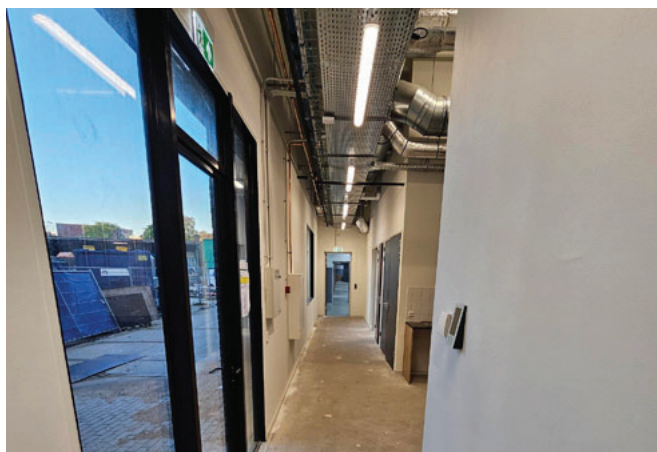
Om geluid en trillingen te dempen voor de omgeving is gekozen voor een box-in-box-principe: een volledig vrijstaande constructie binnen de bestaande muren.
